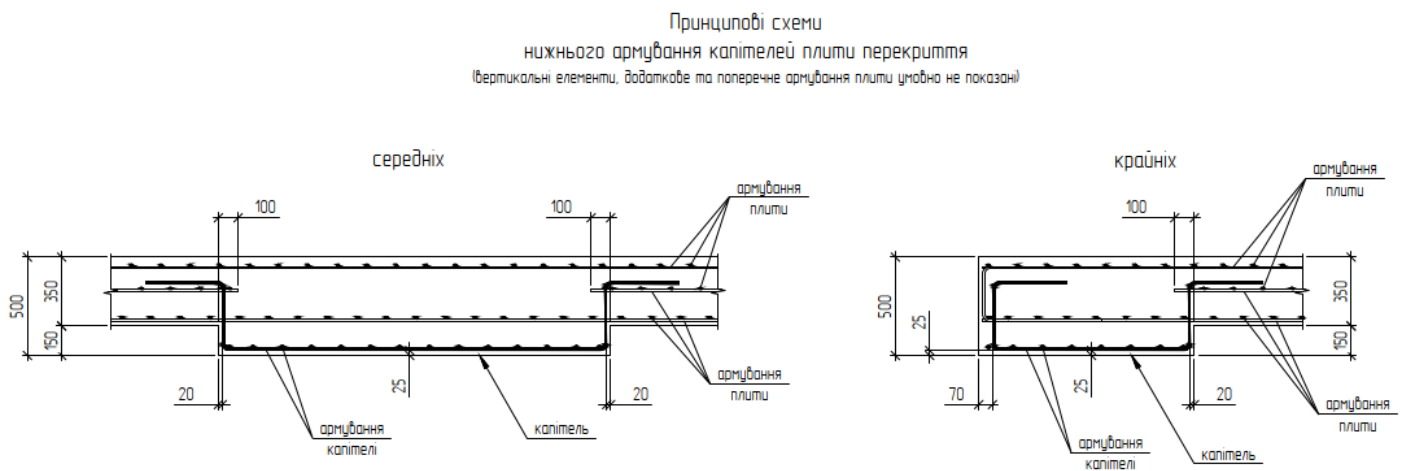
Принципова схема нижнього армування капітелей плити перекриття
